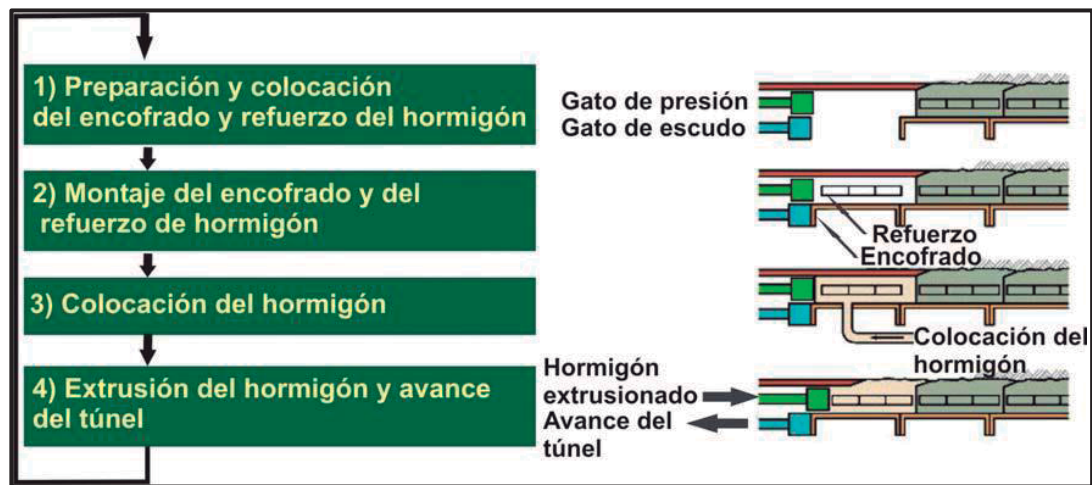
Proceso de hormigonado en cuatro etapas (con armadura)
